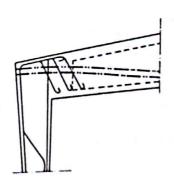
3 - PILAR COM ARMADURA PASSIVA
